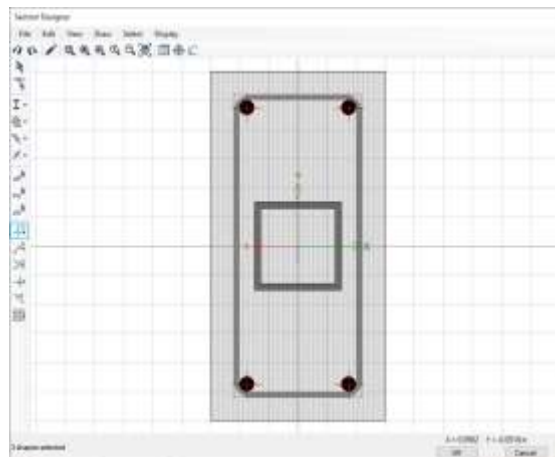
Definición de columna de 30x60 reforzada con perfil metálico tubular cuadrado
